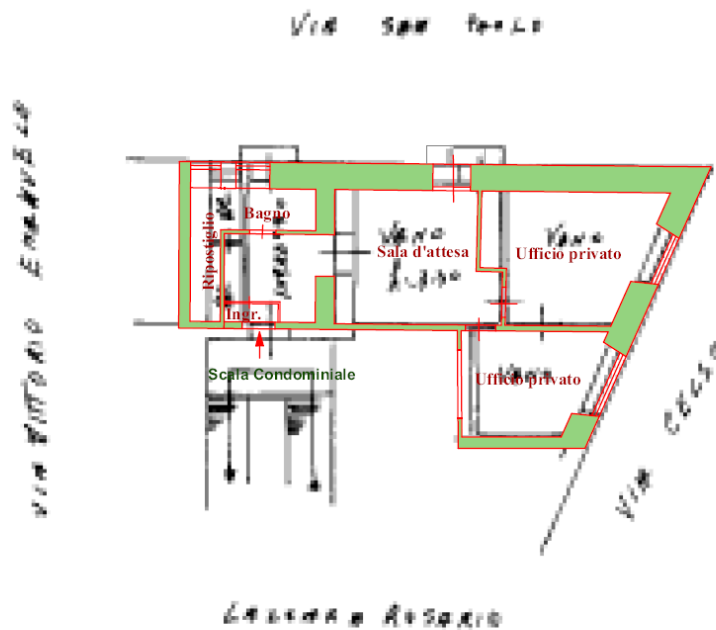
Planimetria catastale sovrapposta con lo stato attuale
